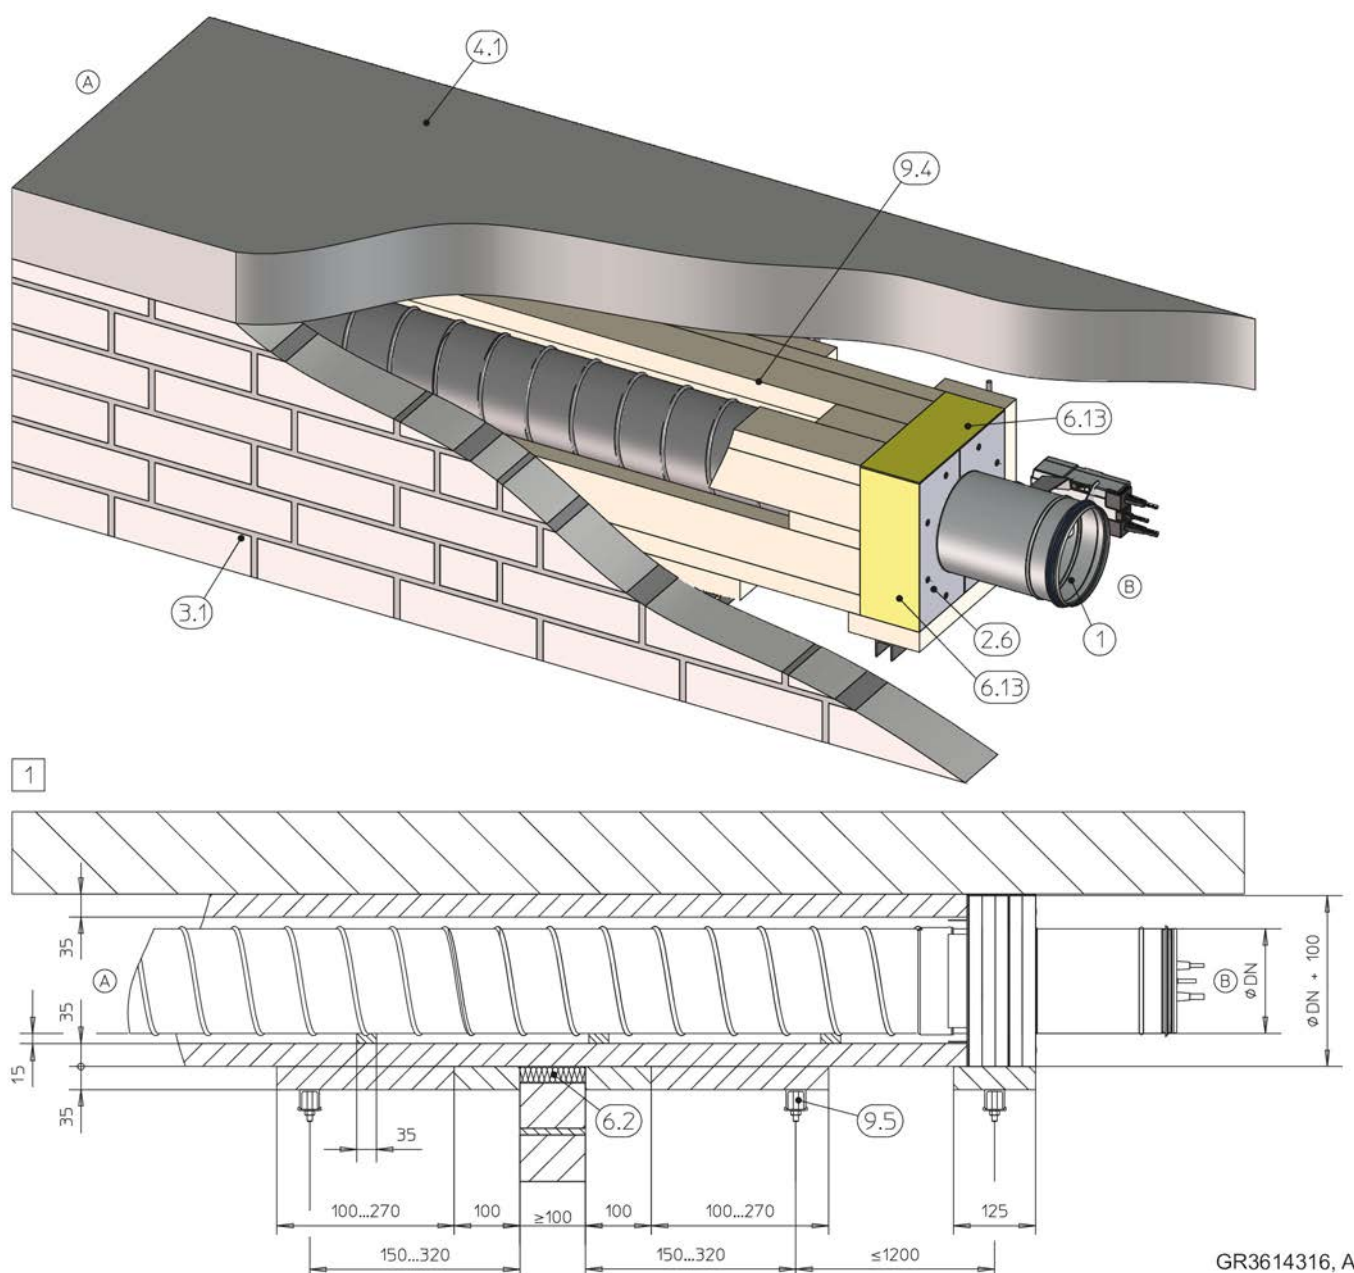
Installazione a secco senza malta lontano da una parete piena con attraversamento della parete, rivestimento su due lati
